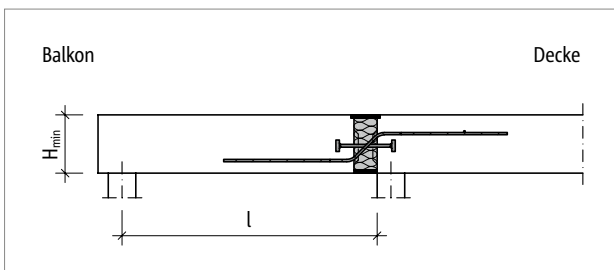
Schöck Isokorb® T Typ QP: Statisches System
